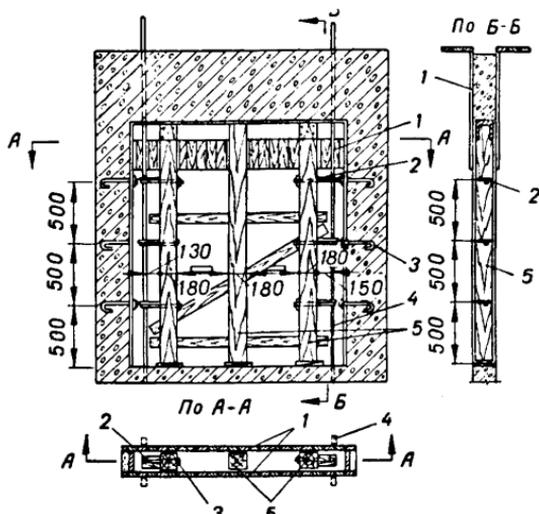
Схема закрепления домкратных стержней при помощи болтов с крюком:
